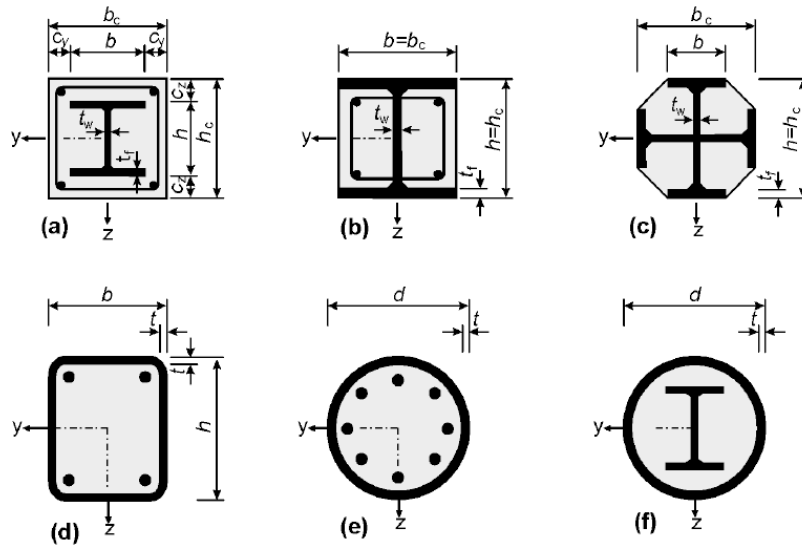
Secciones transversales típicas de pilares mixtos y notación
